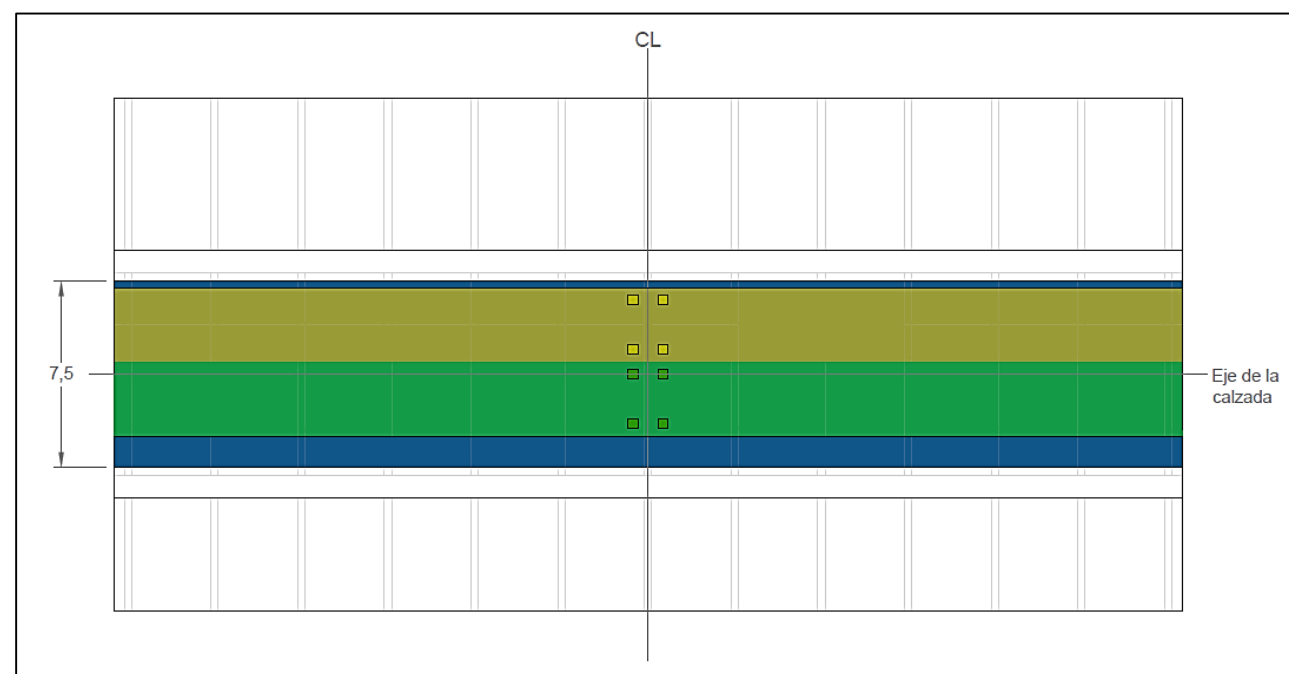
Caso 5 de sobrecargas de uso – Planta. Elaboración propia con AutoCAD
